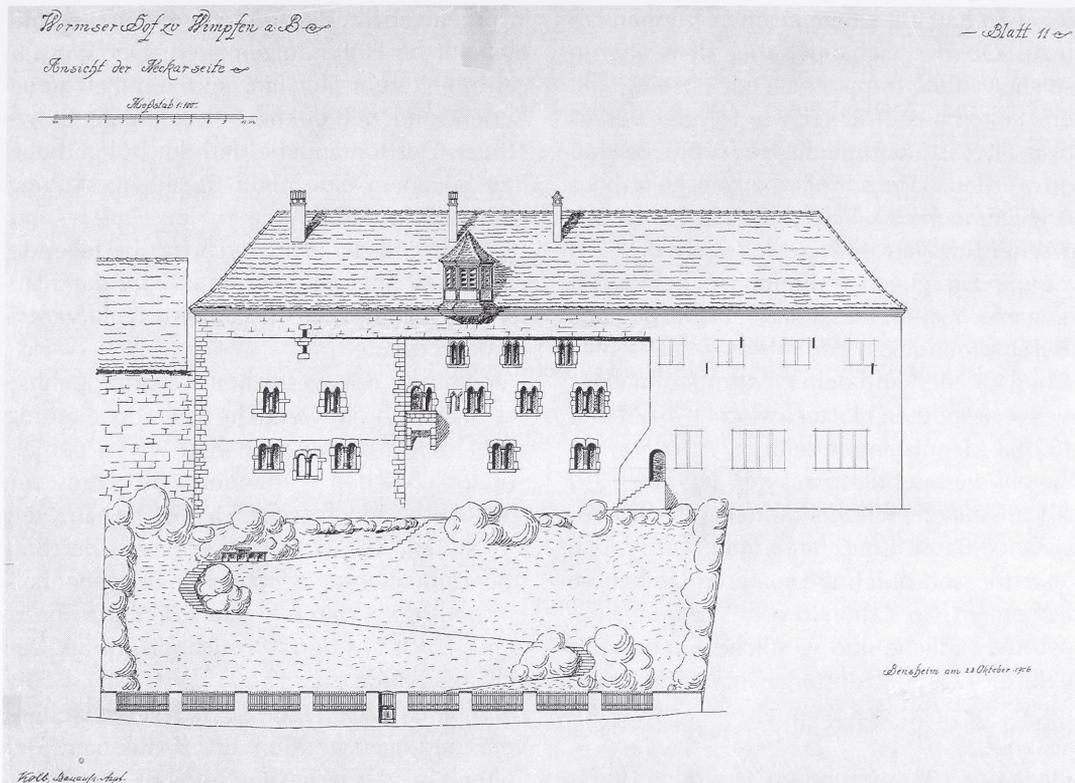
Bad Wimpfen, Wormser Hof. Plan der Nordfassade 1906.
